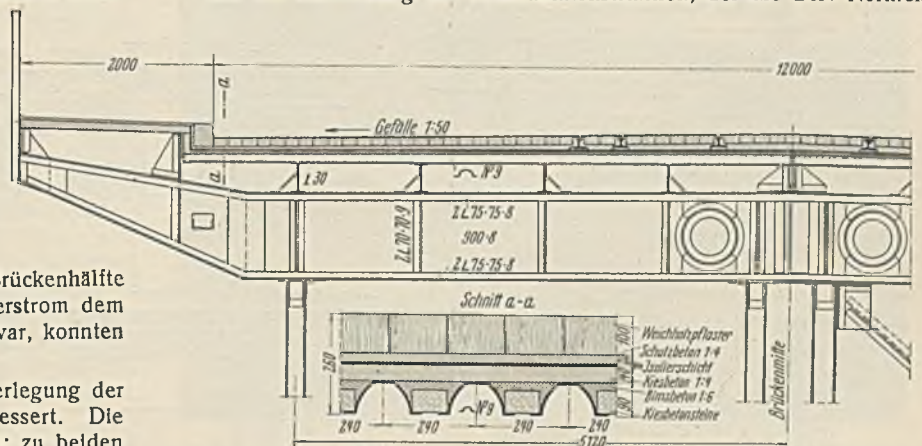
Querschnitt der Brückenfahrbahn nach dem Umbau.
